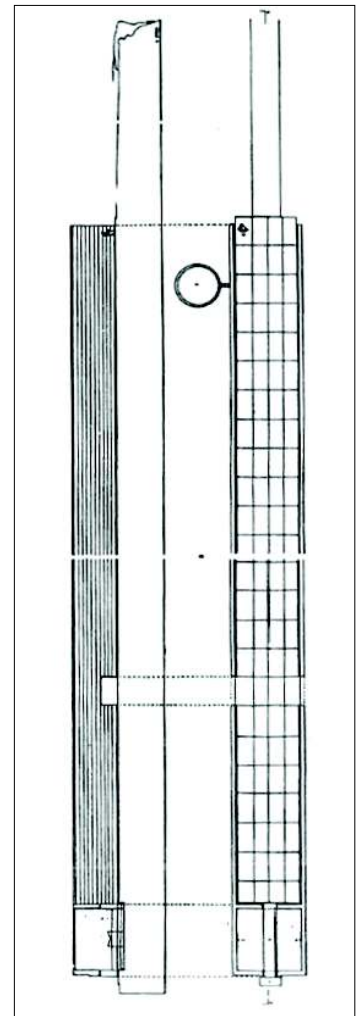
/XXI- Idem, *Via dos Descobridores*, Planta e Alçado Poente.
